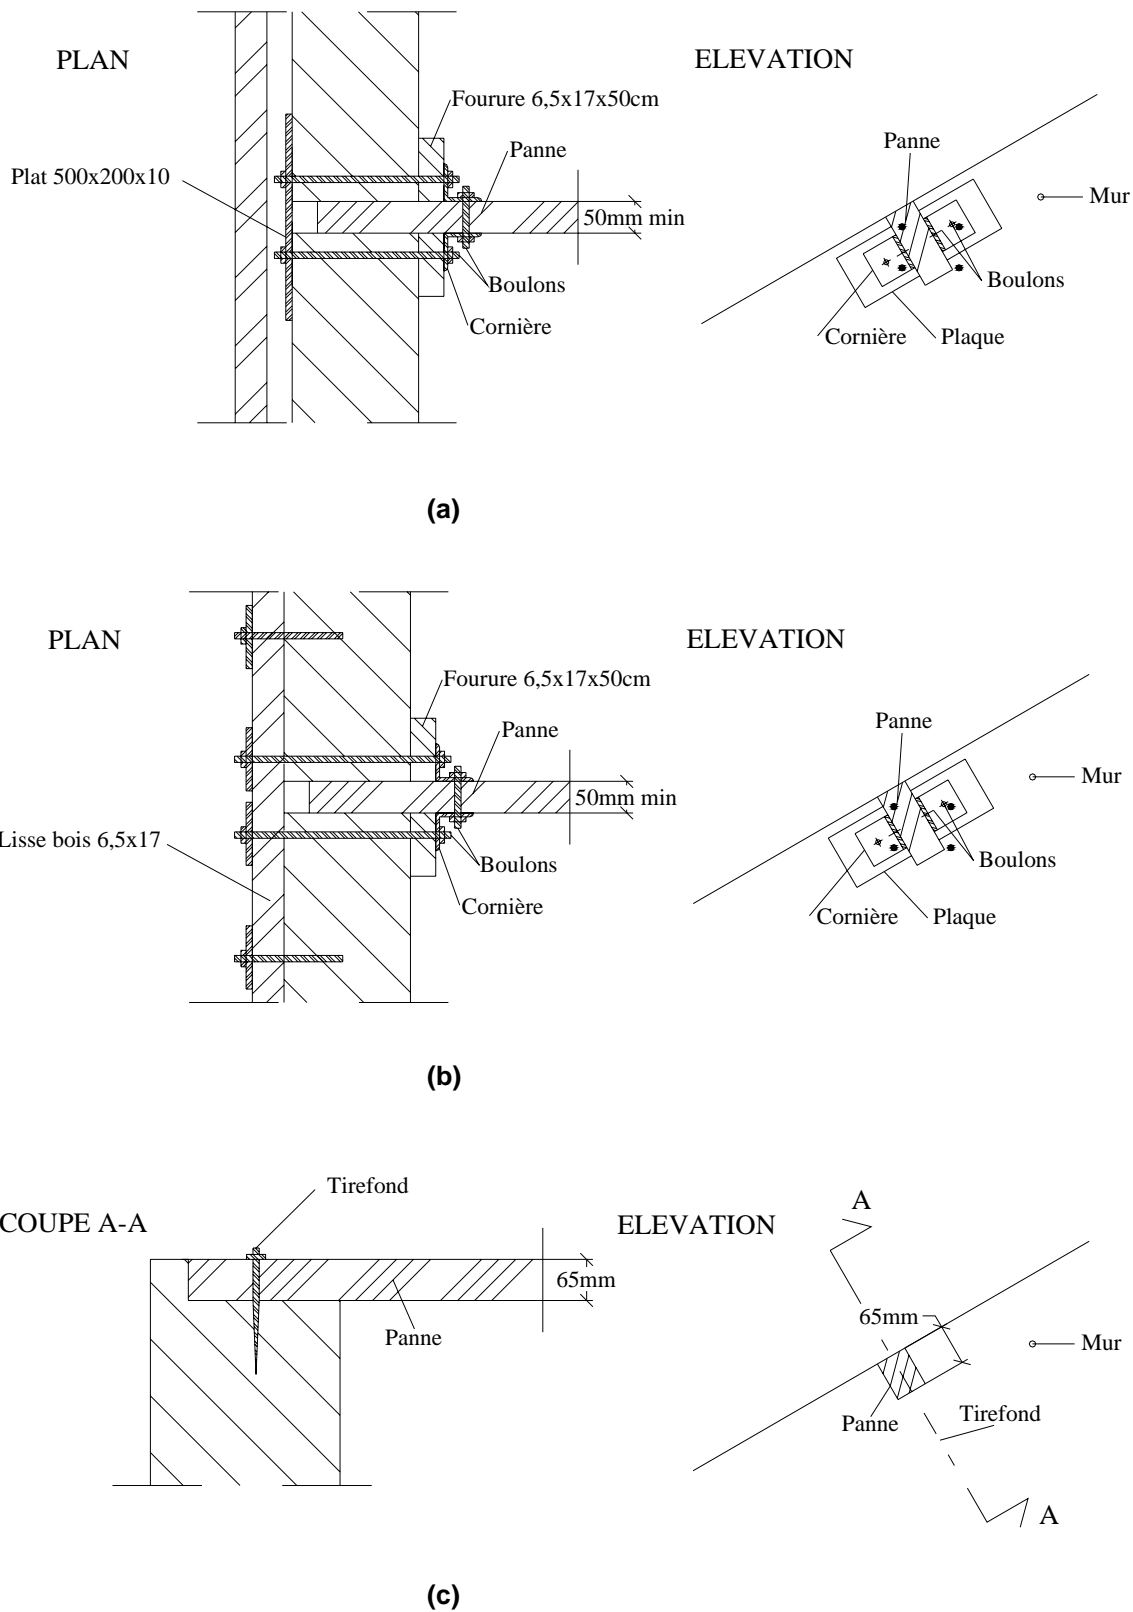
Exemples de liaisons panne – mur pignon (a) ancrage par boulons (b) ancrage par plats pliés et cornières (c) ancrage par tirefond, applicable pour panne de faible hauteur.
